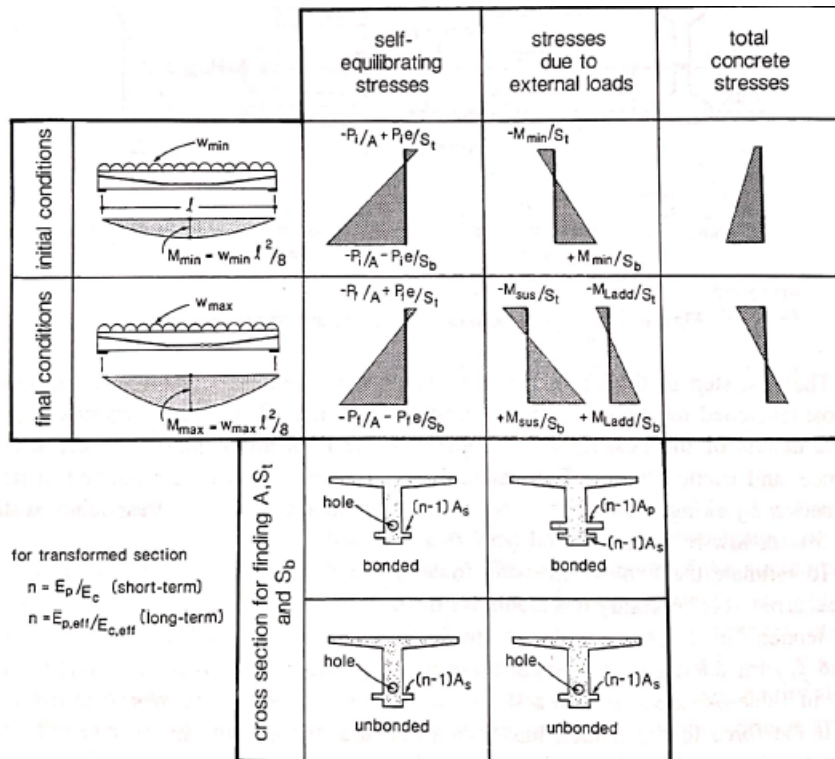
Cálculo de esfuerzos en el concreto por metodología de la fuerza en el torón [18]
